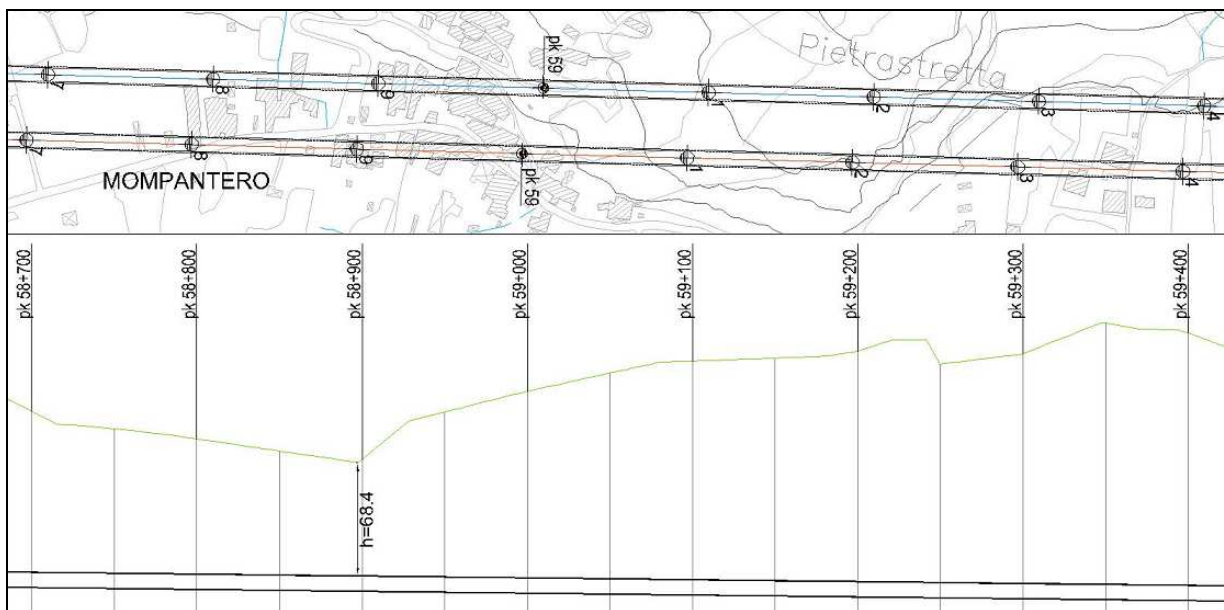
Stralcio Sottoattraversamento Mompantero - Planimetria + Profili 2d13
